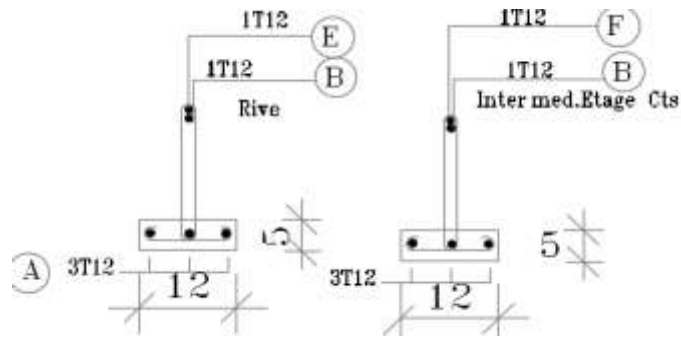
Schéma de ferrailage de plancher à corps creux
